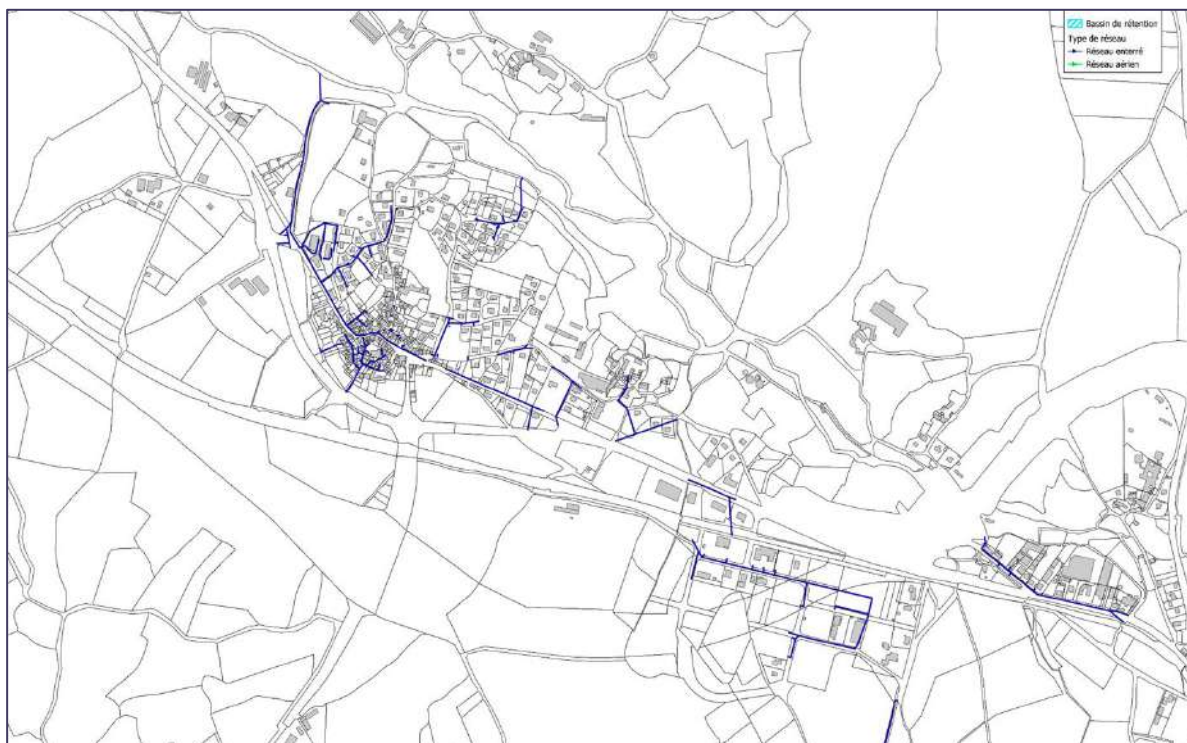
Plan du réseau pluvial de Lapanouse – 5.2 km (plan SIG transmis par la commune)
